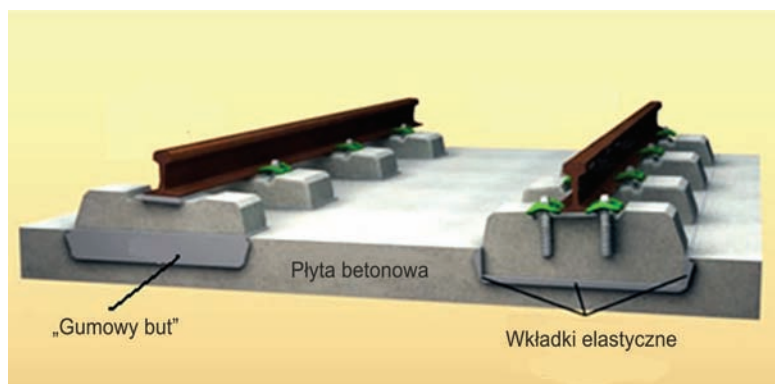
Konstrukcja nawierzchni typu STEDEF zastosowana w Neuilly-sur-Marne (1970): płyta z betonu sprężonego z elastycznie posadowionymi podkładami dwublokowymi [10]
